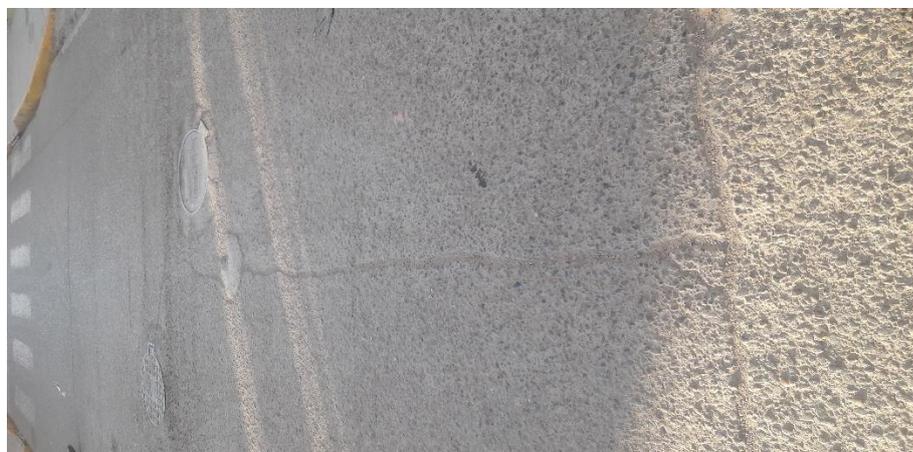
11.Falla Grietas Longitudinales y Transversales, Avenida Mariano Núñez.
